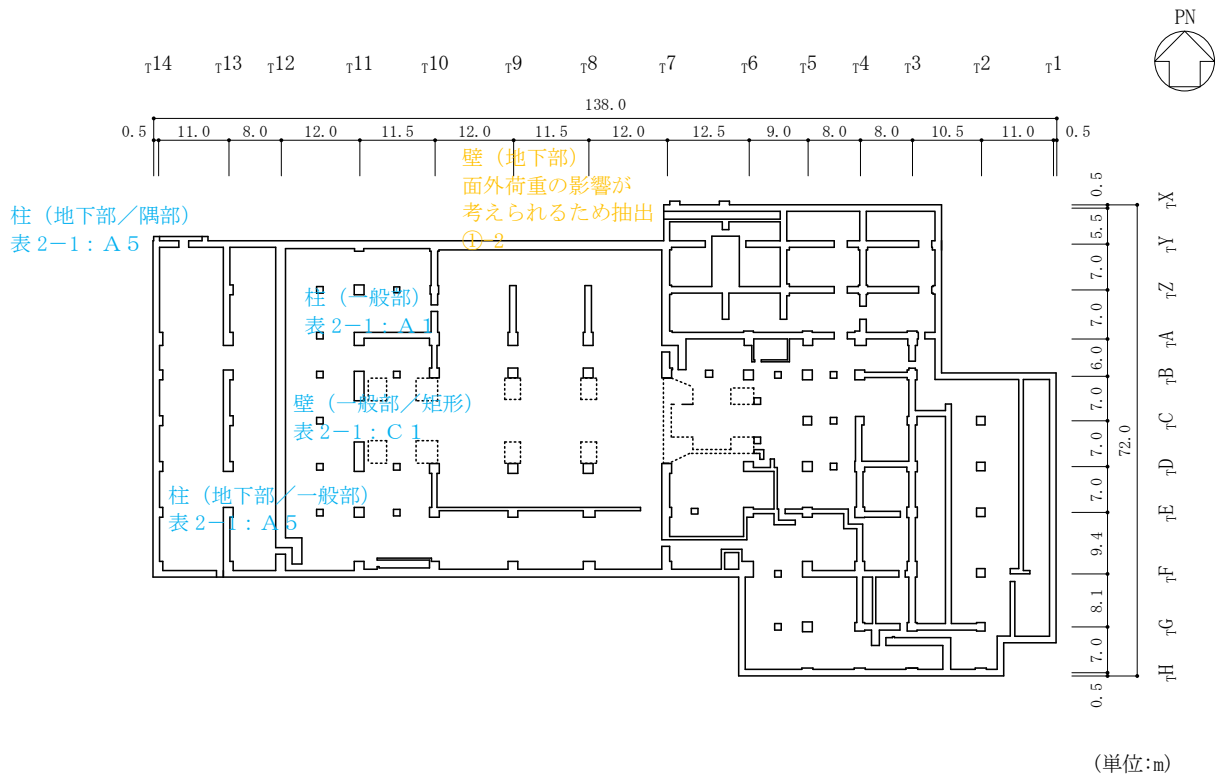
(1) タービン建物の概略平面図 (EL 2.0m)
